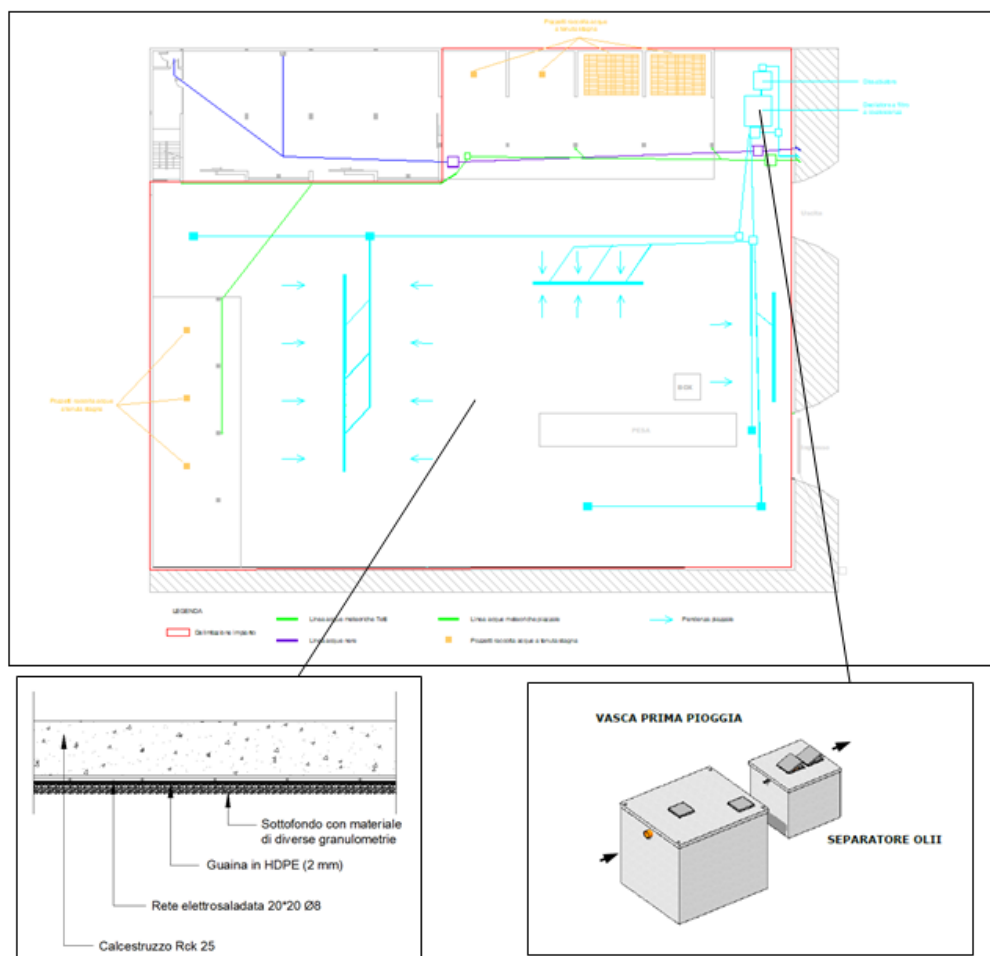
Planimetria impianto con particolare impianto trattamento acque meteoriche
